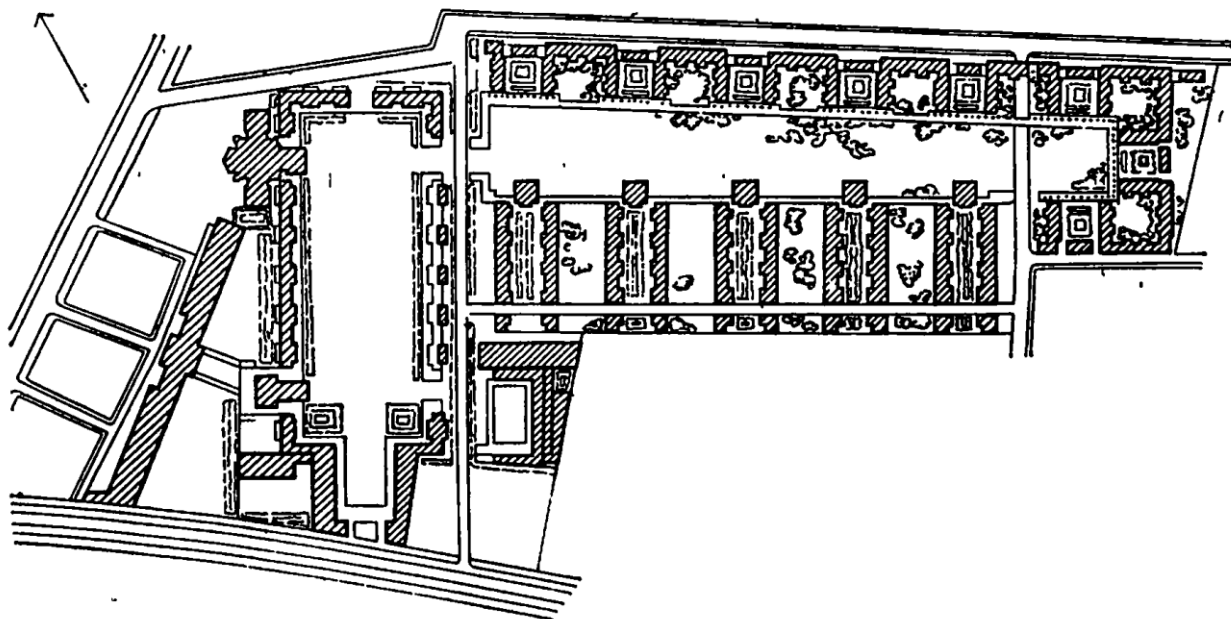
Генеральный план жилого комплекса «Ла Мюэт» в Дранси
